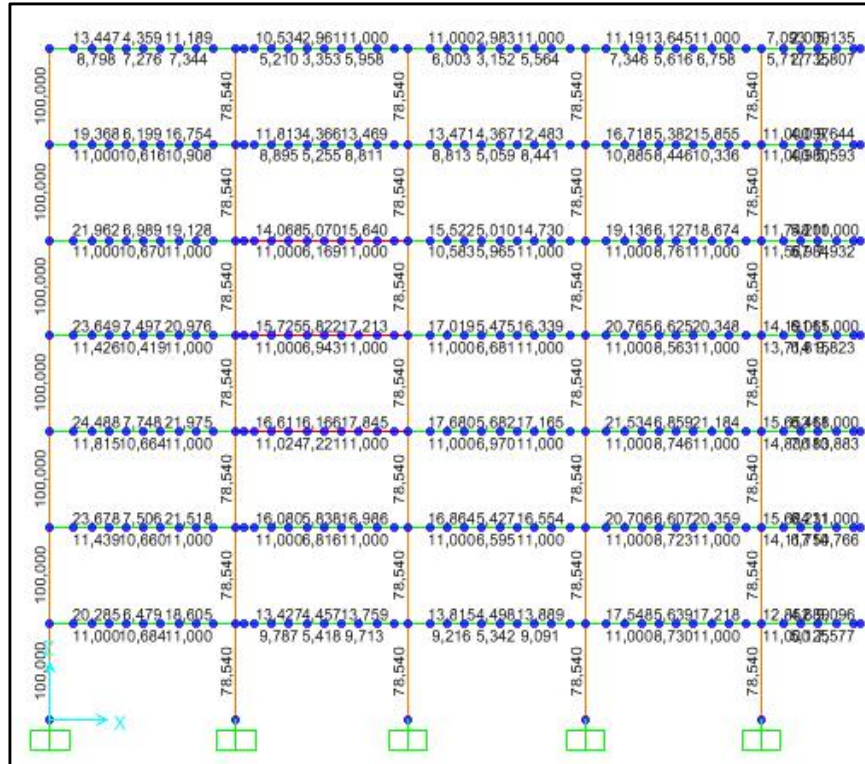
Acero en vigas pórtico M (Crítico en x), Hall Central
